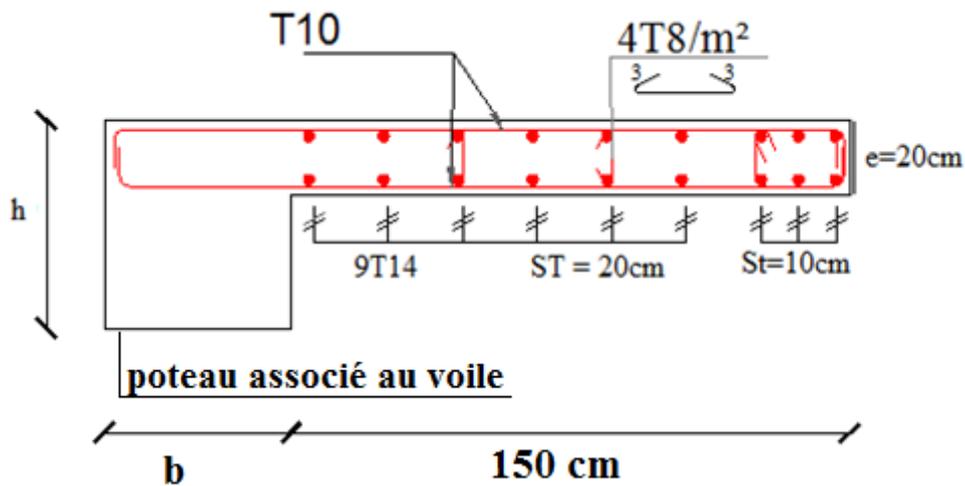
Schéma de ferrailage du voile Vx1 au niveau 3,4,5 et 6 .
